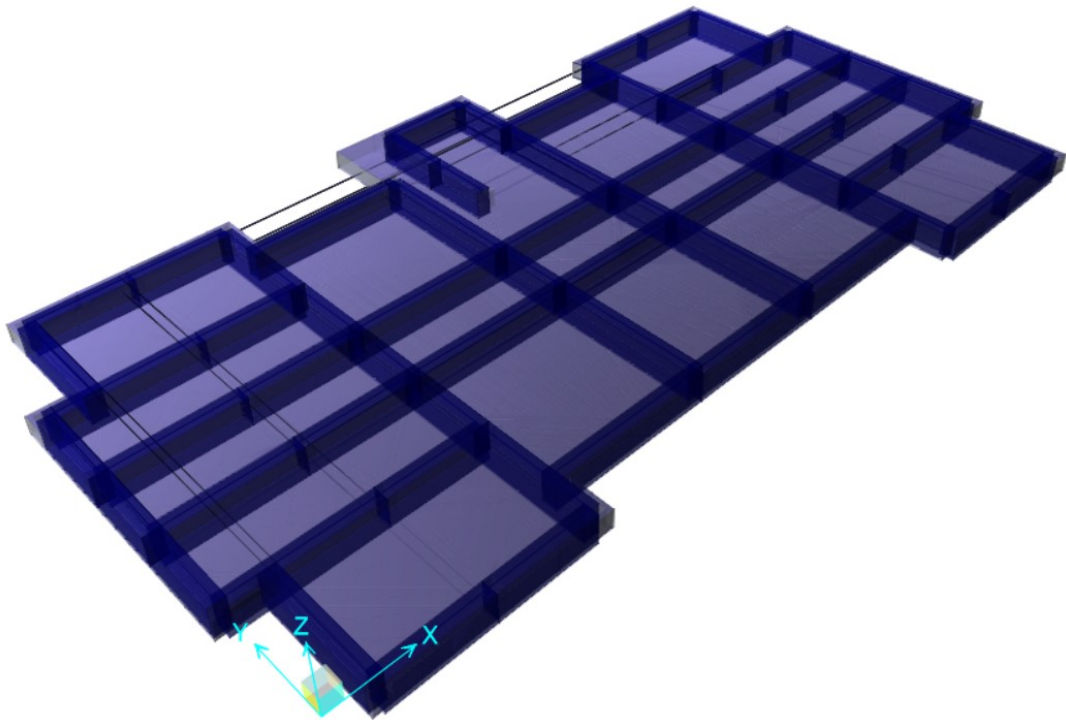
Modelamiento Subestructura Sistema Dual – Edificio Blesser. Vista 3D. Fuente: Elaboración Propia.
